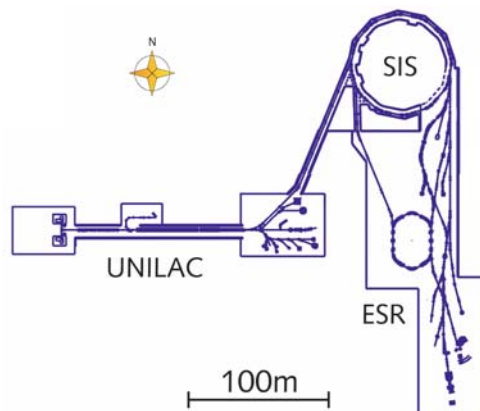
Grundriss der Beschleunigeranlage (GSI 2004)
